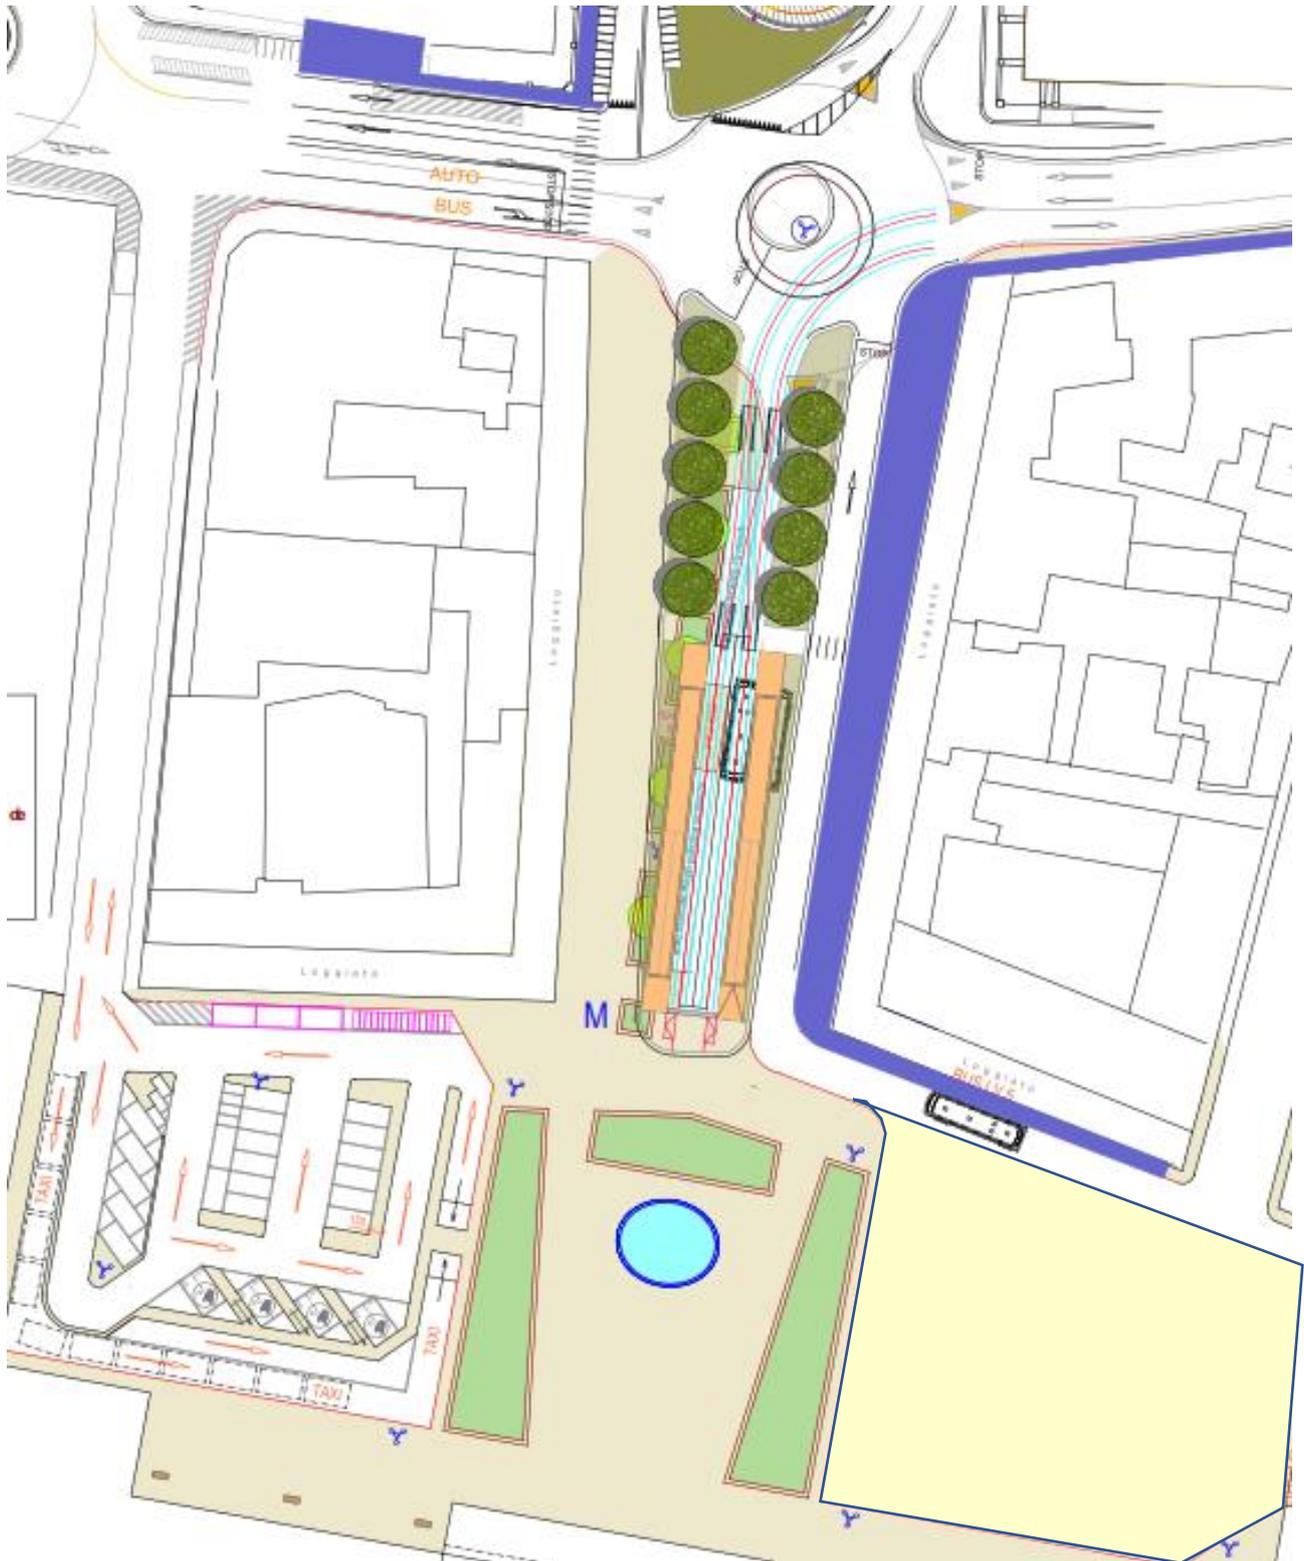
Planimetria del progetto di riqualificazione dell'area della Stazione Centrale
